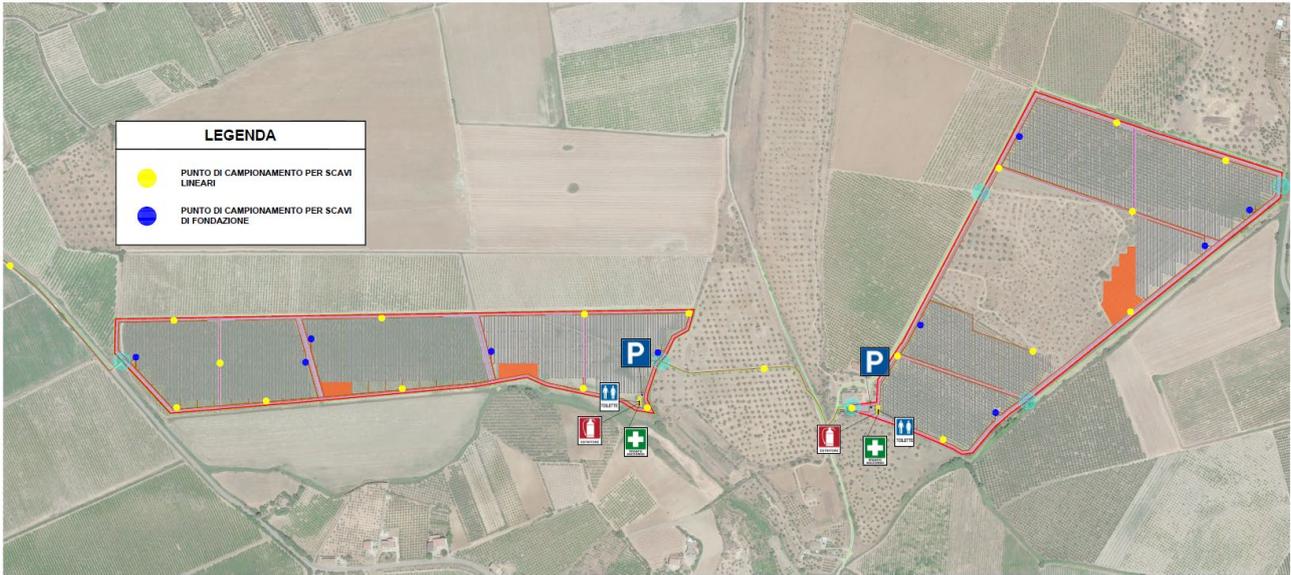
Layout impianto con piano di campionamento – Impianto aree G, F
